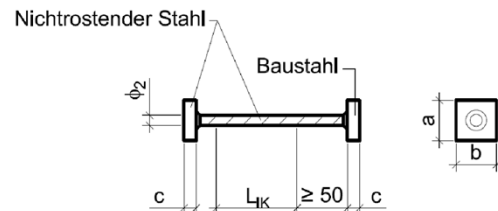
Druckelement aus Stahl mit angeschweißten Druckplatten, einseitig min. 50 mm, einseitig kleiner 50 mm einbindend (bspw. für Schöck Isokorb® Typ O)
